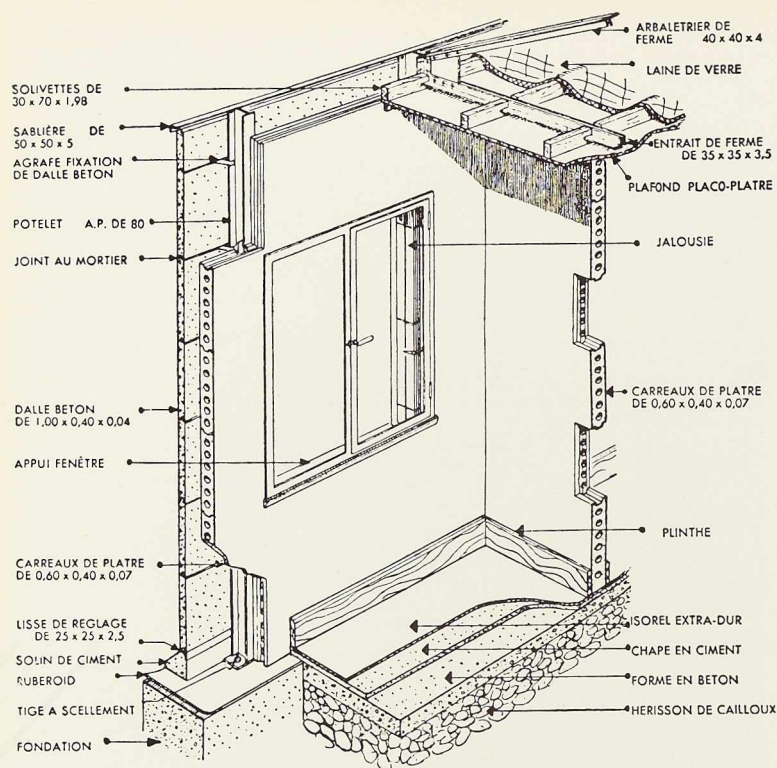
Maisons permanentes. Rez-de-chaussée. Détails techniques.
